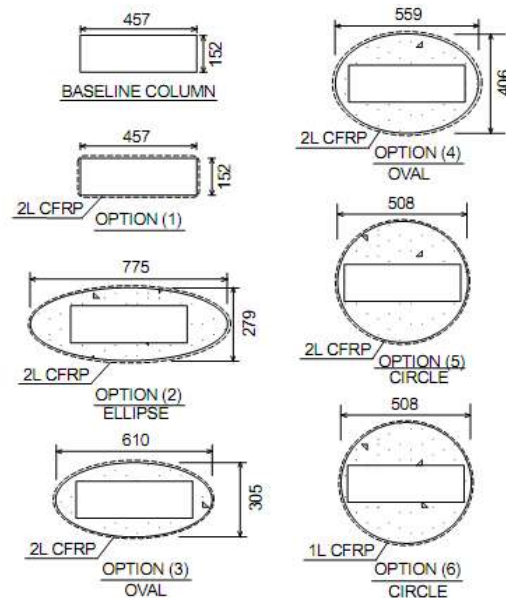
Opciones de refuerzo (Yan et al., 2008).
